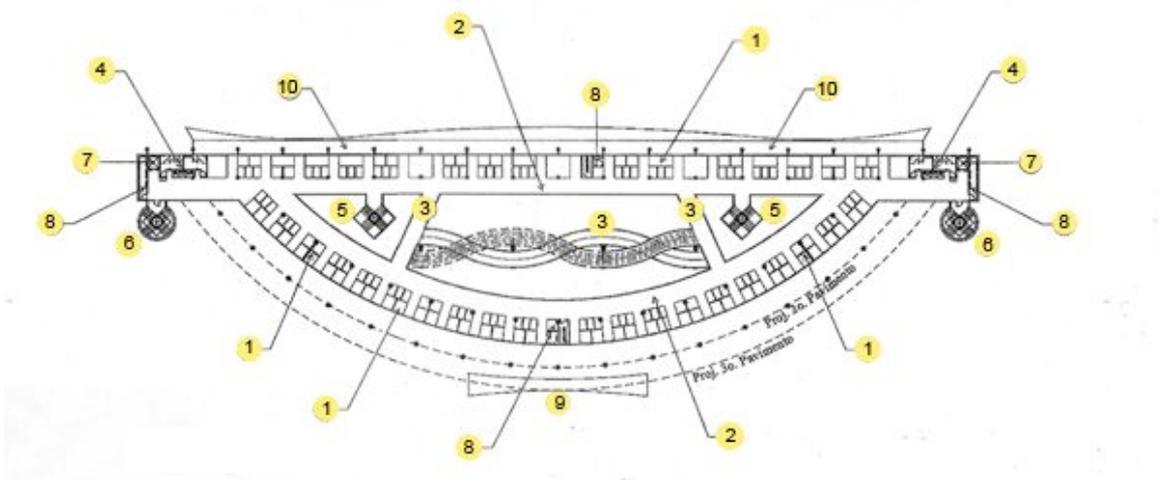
PLANTA DO 1º PAVIMENTO (lojas)
